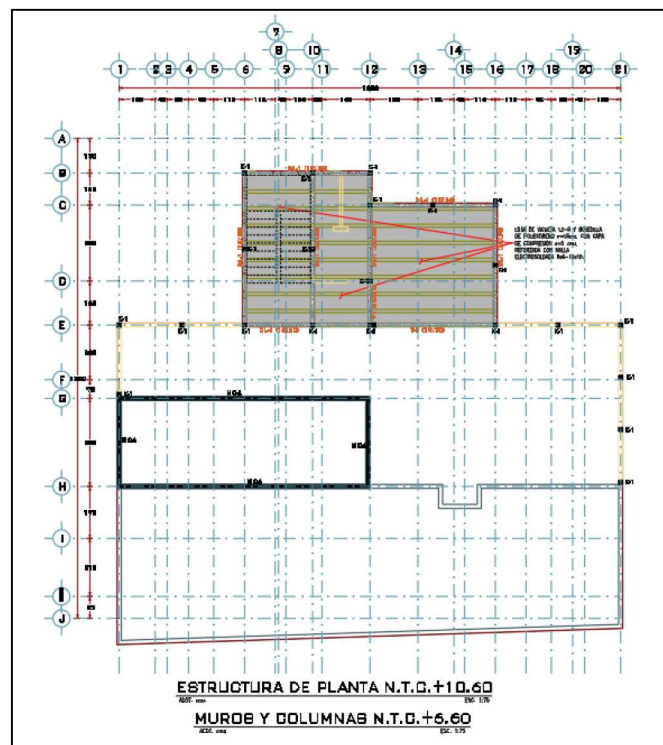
Losa de vigueta y bovedilla, losa de azotea que delimita solo al cubo de escalera, para acceso a la terraza.
